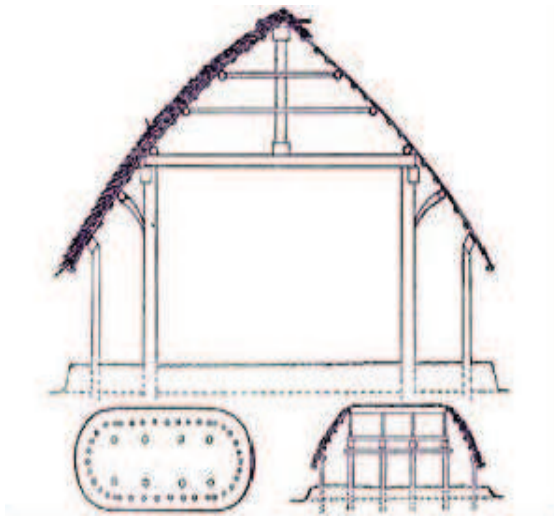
Schnitte und Grundriss Fale Afolau
